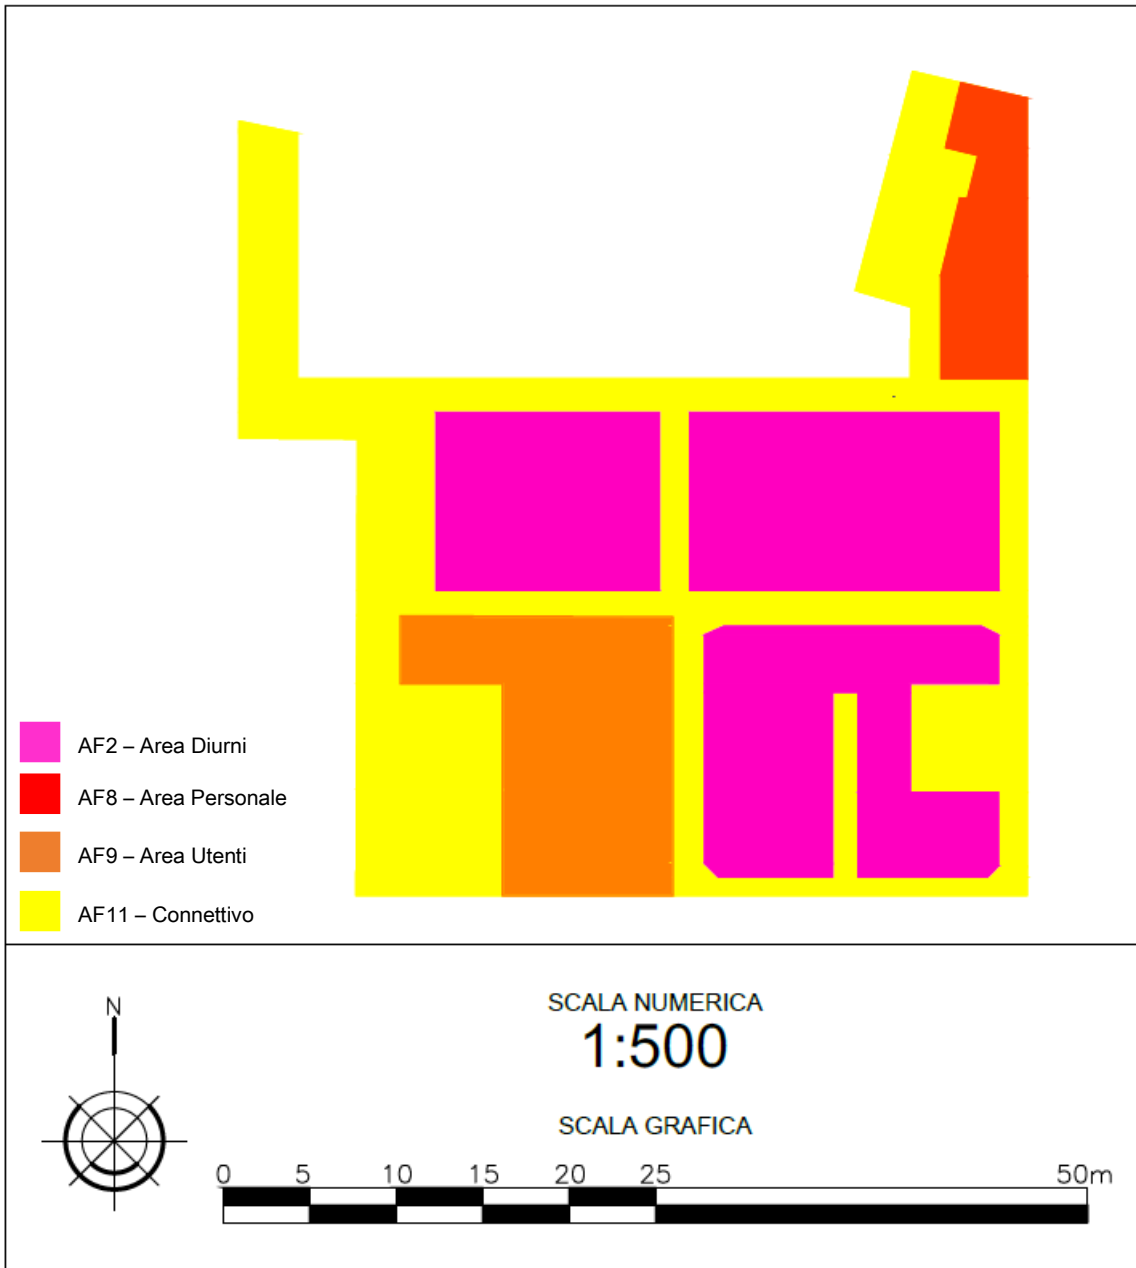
Ospedale UMC Imaging Center - Planimetria Piano Tipo
